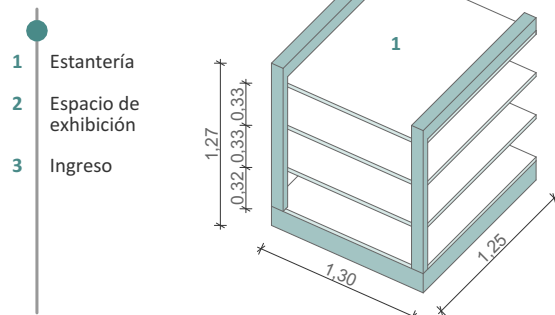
Axonometría de estantería. Fuente: Autores.
